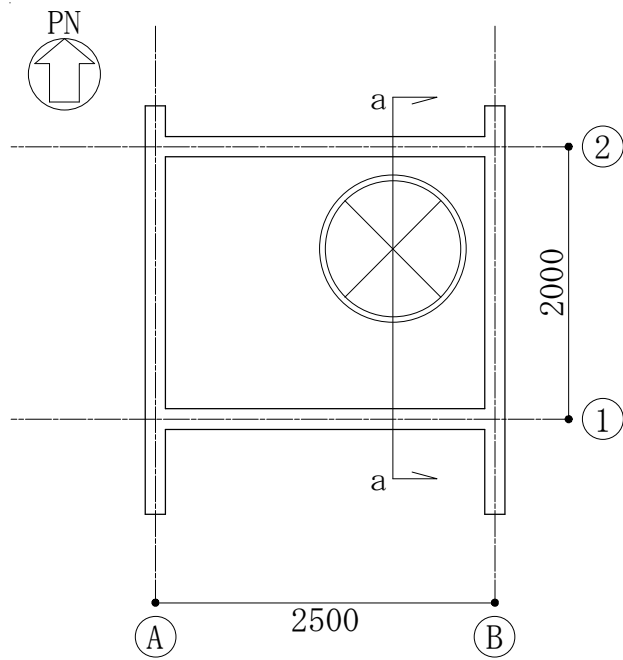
地下排水上屋及び排水シャフトの概略平面図（南西隅）
